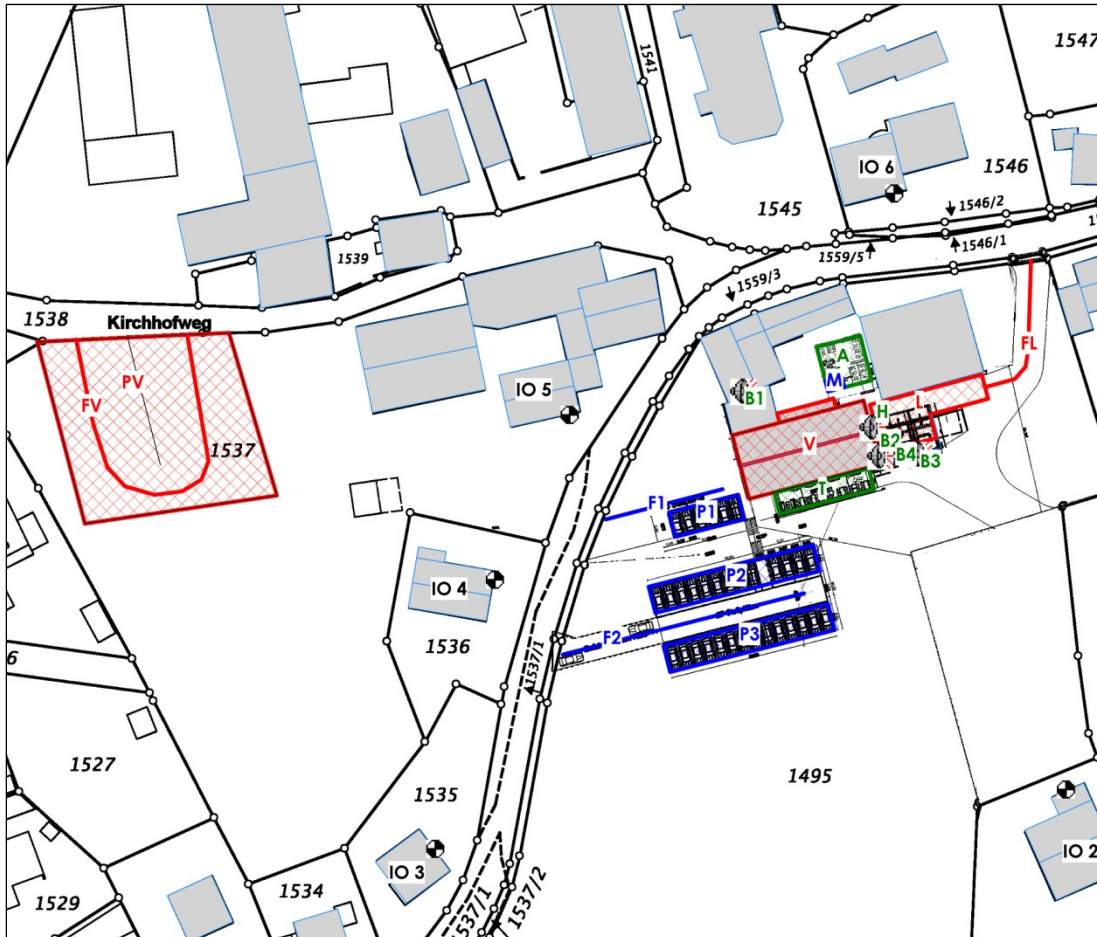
Lageplan mit Darstellung der Schallquellen
